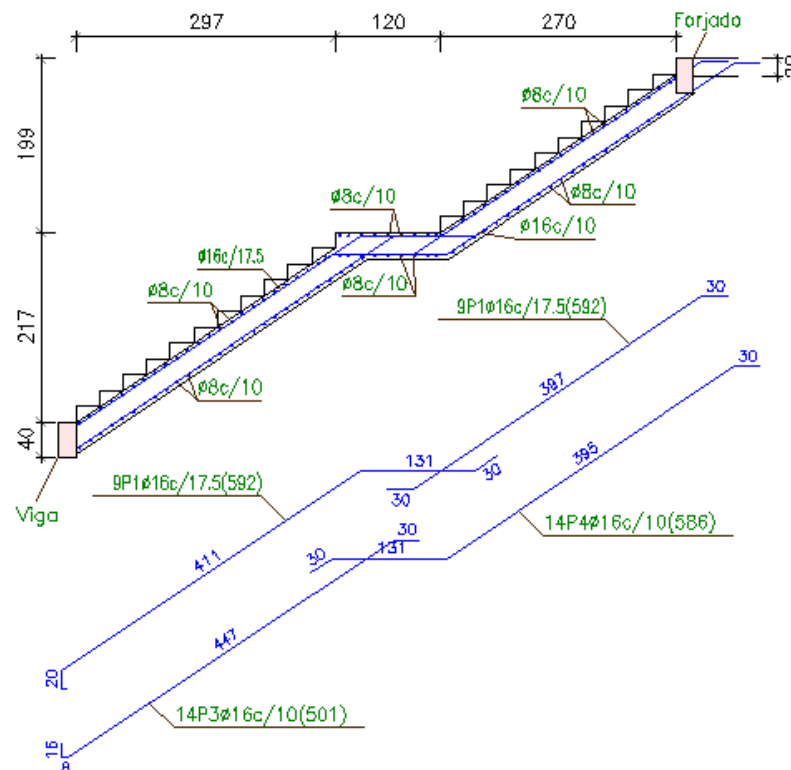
Despiece de Armadura; Elaboración Propia.
